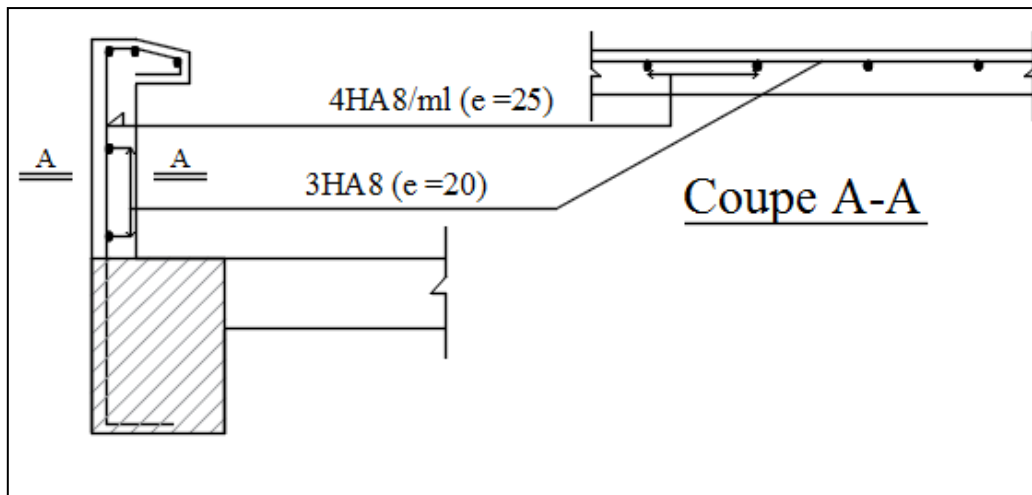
Coupe de ferrailage de l'acrotère.
